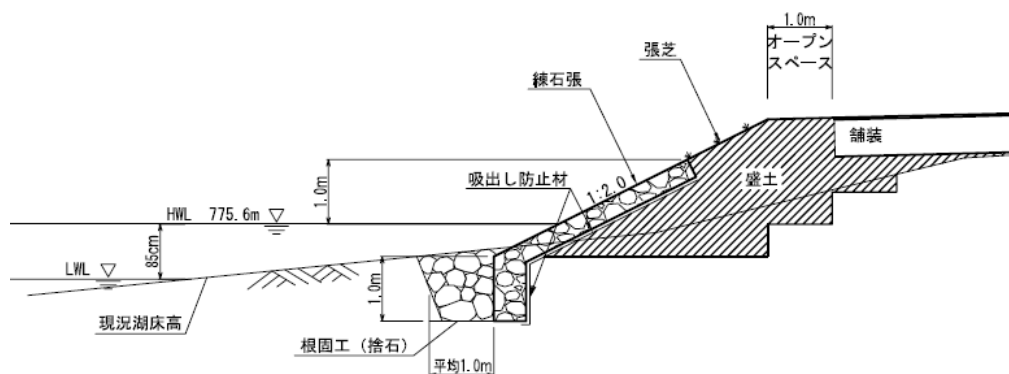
湖岸道路沿いの護岸標準断面図
